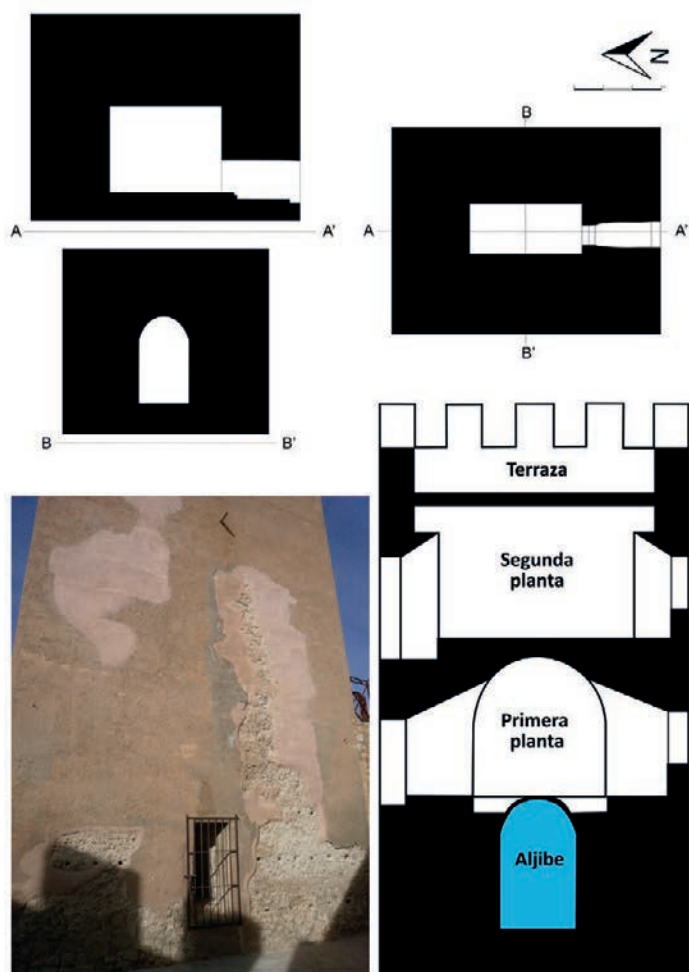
Vista exterior y sección de la torre, y planta y secciones del aljibe I (Archivo Museo Dámaso Navarro).
